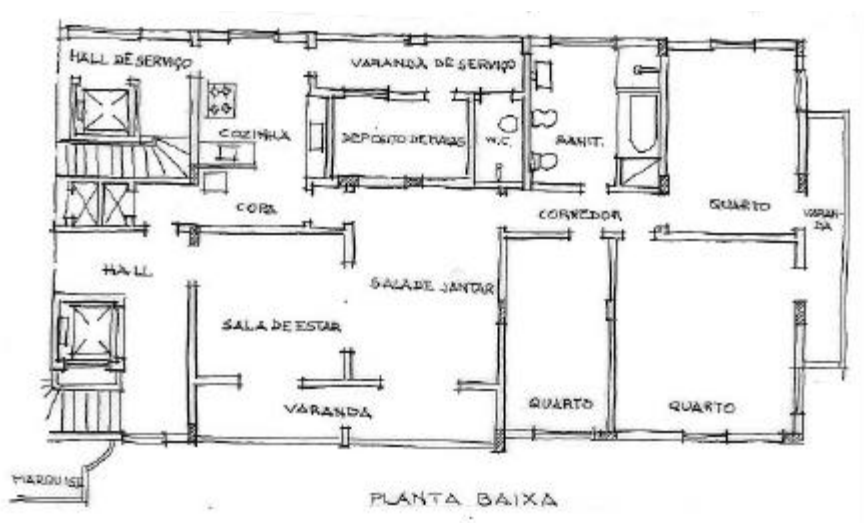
Edifício Maíza: planta baixa do apartamento tipo, localizado na parte posterior (fachadas norte e oeste) do prédio.
